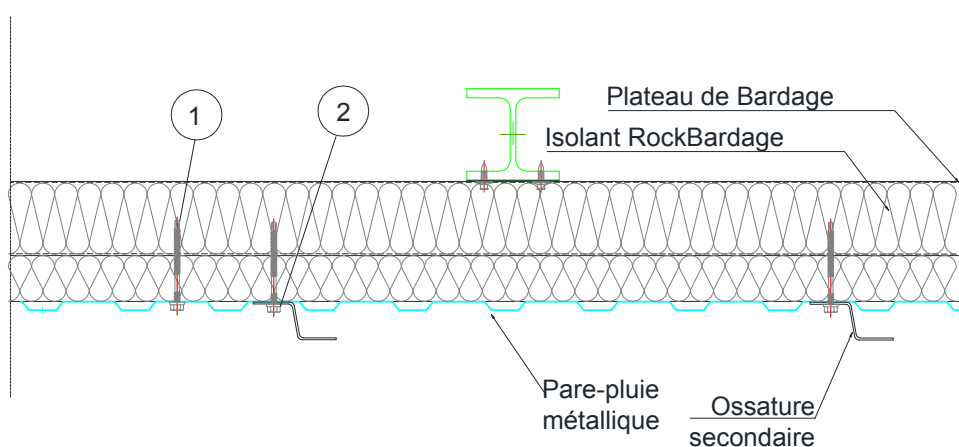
Traitement des joints horizontaux entre panneaux
